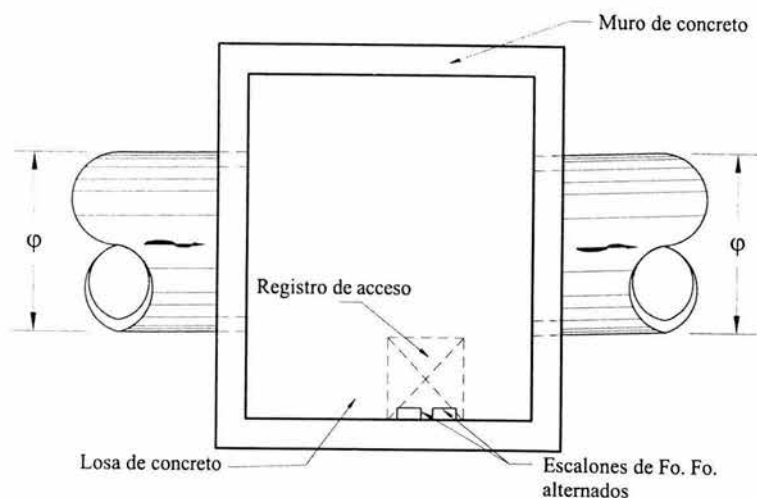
PLANTA POZO-CAJA DE UNIÓN
